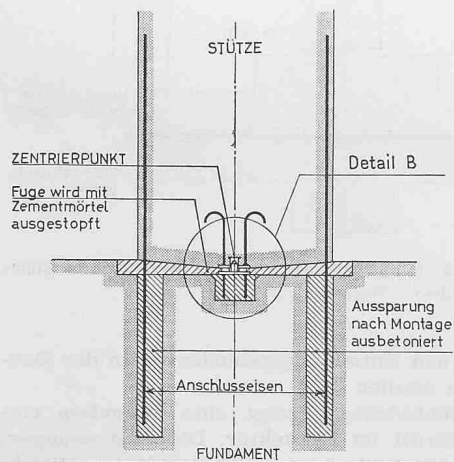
Biegesteifer Anschluss der vorgefertigten Untergeschoss-Stützen an die Fundamente. Masstab 1:60. Grösste Last auf Fundament rd. 1400 t.
